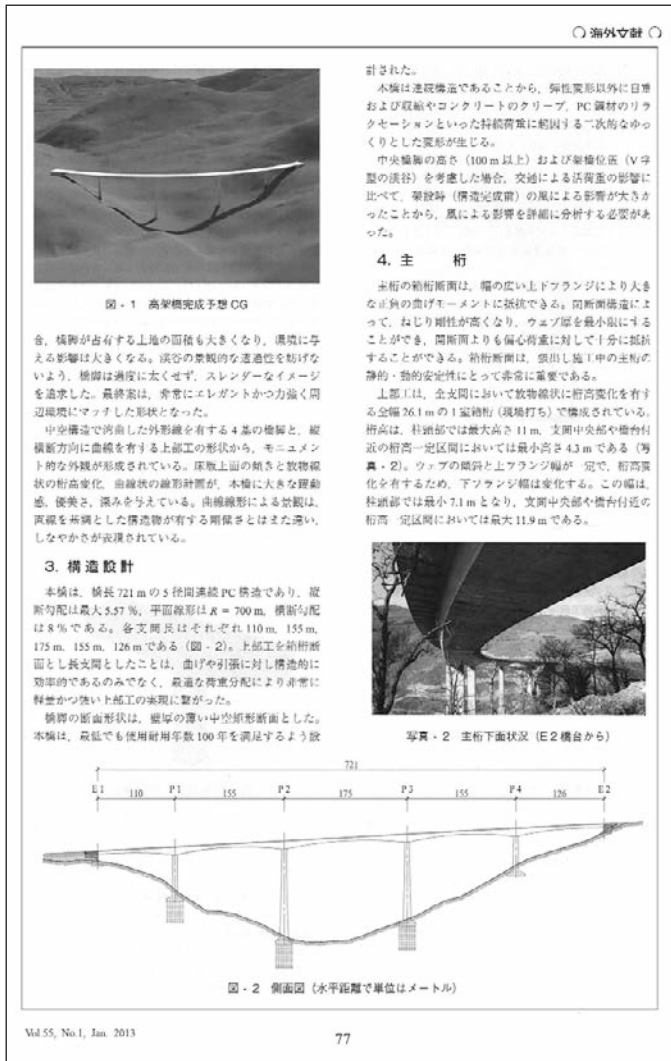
Viaducto de Montabliz, publicado en Journal of Prestressed Concrete, Japan
